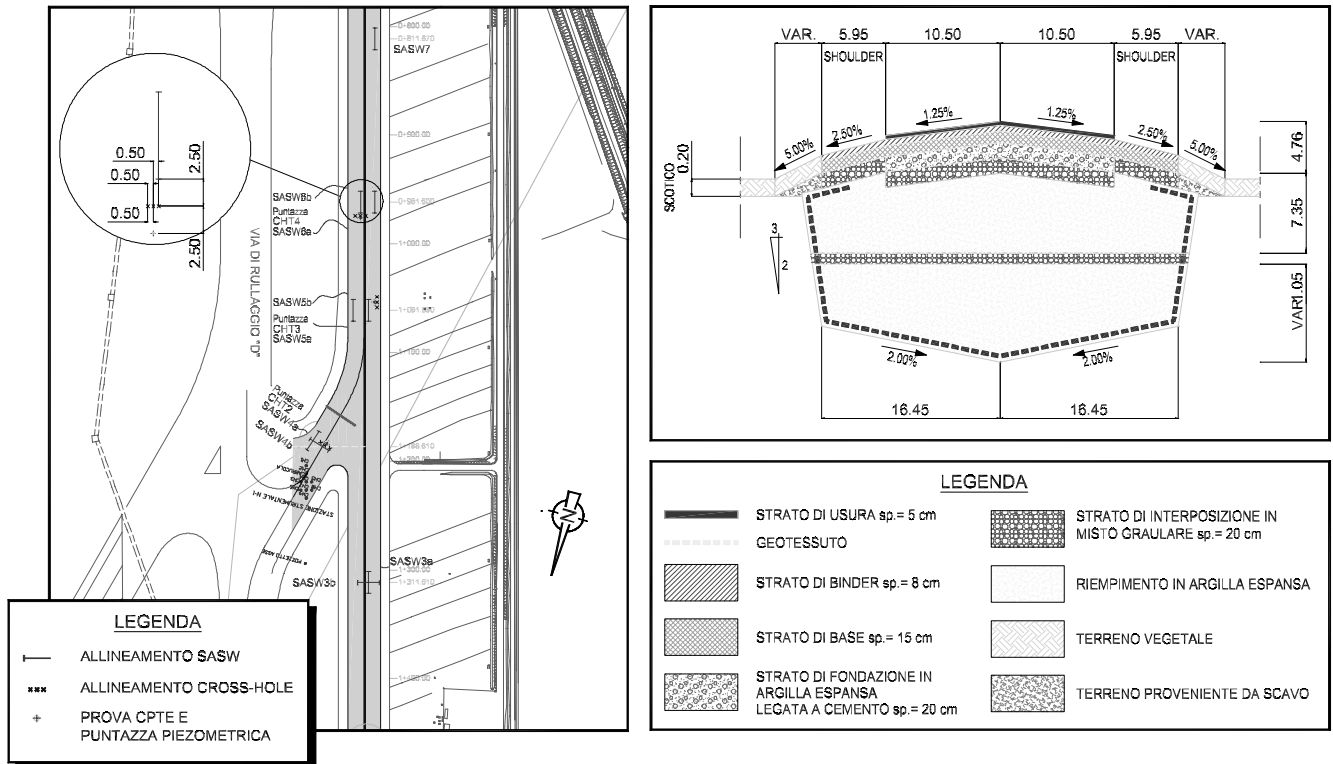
Stralcio planimetrico con ubicazione degli stendimenti SASW e sezione tipo pista “Charlie” aeroporto Leonardo da Vinci (SGI, 1999)
